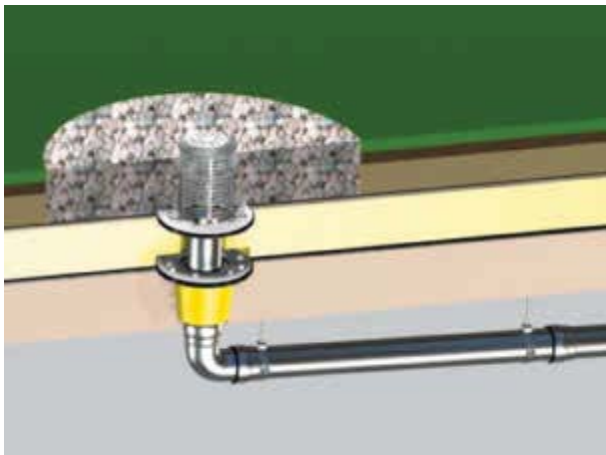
Dachablauf für Einbau in ein Warmdach mit 0,50 m breitem Kiesrand, der das Zuwachsen verhindern soll
